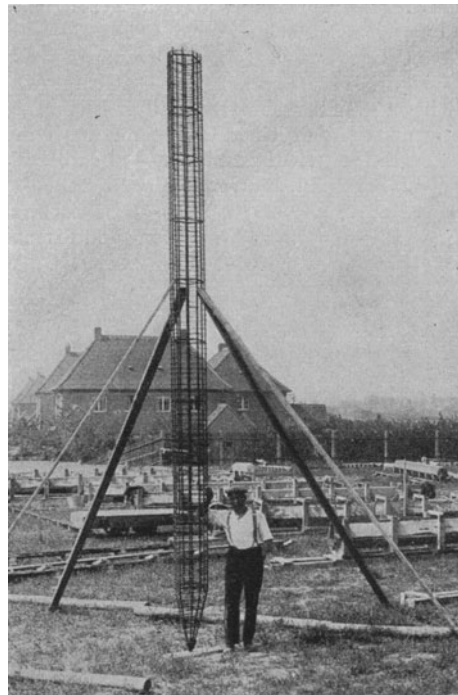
Bewehrung eines Eisenbetonrammpfahles. (Nach H. Holzapfel: Beton u. Eisen 1930 S. 103.)
